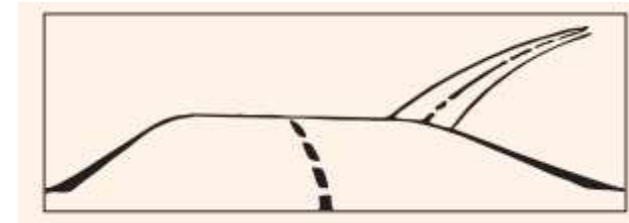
Situaciones a evitar en la coordinación planta alzado (IV)
